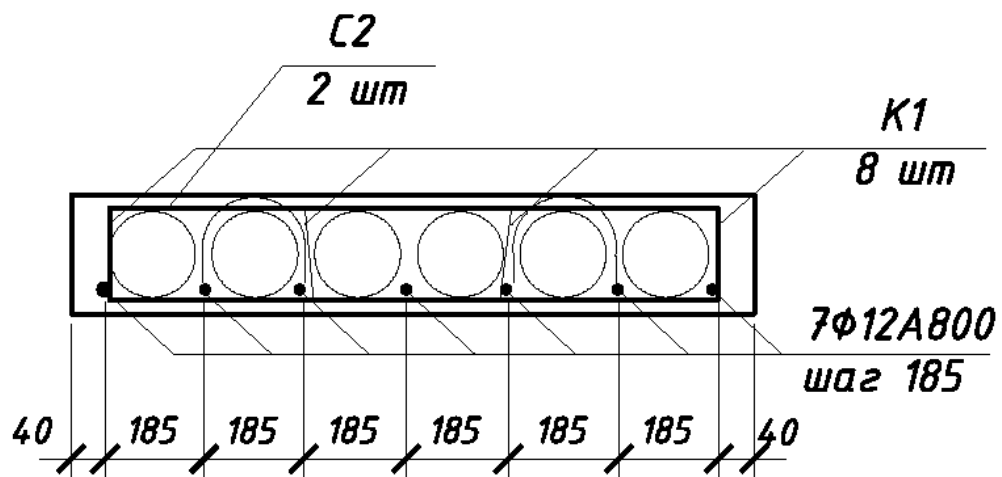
Схема армирования плиты с продольной рабочей арматурой
